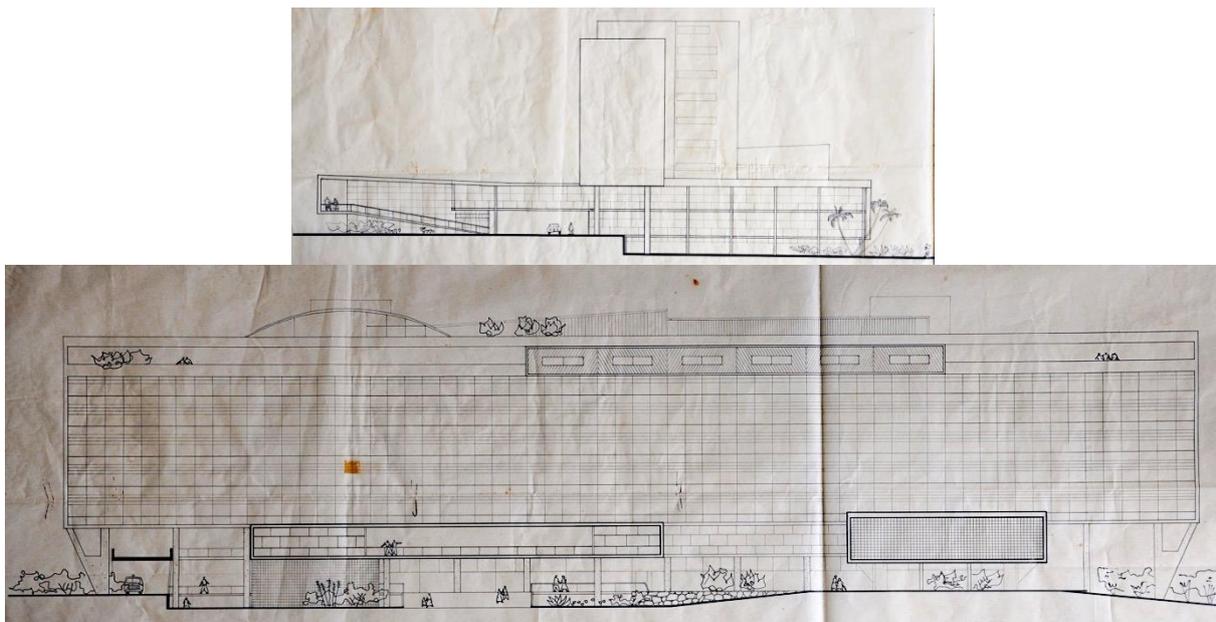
Projeto de 1953: Fachadas Norte e Leste. Fonte: Arquivo da SSEPE.
